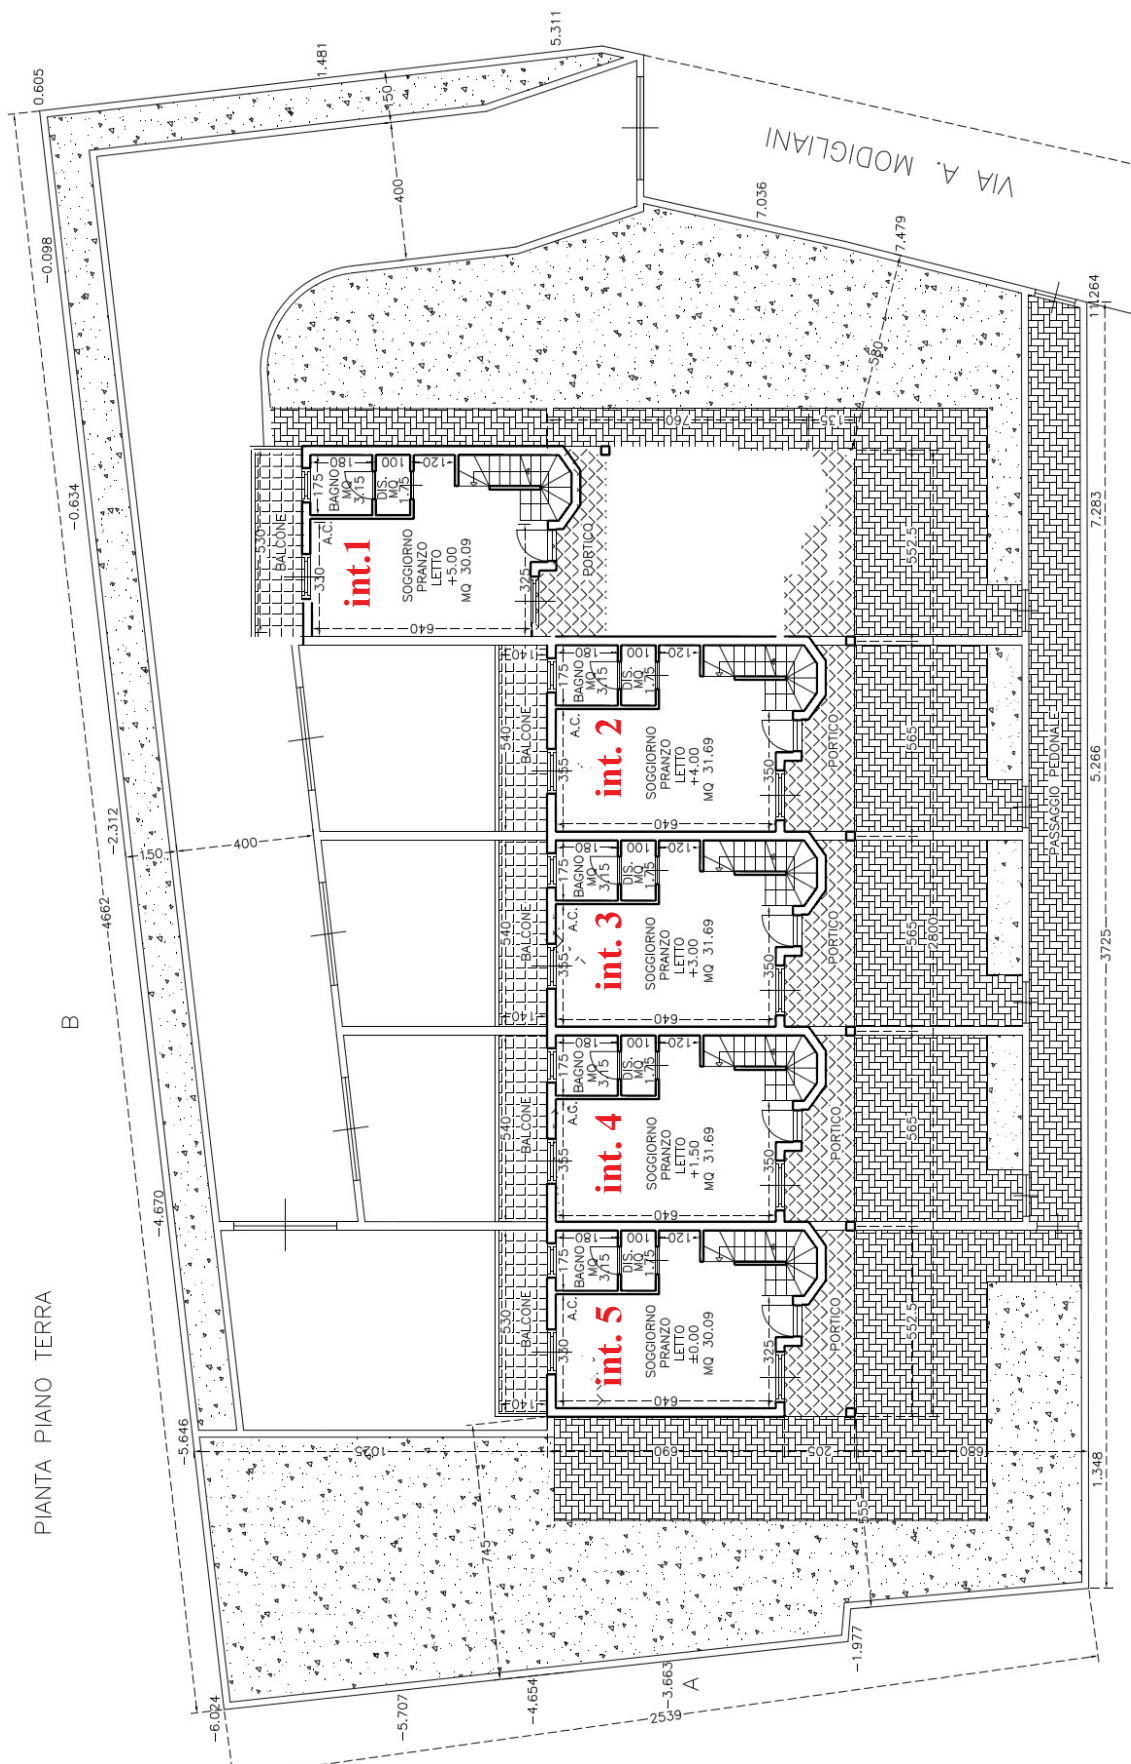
Planimetria del manufatto edilizio
